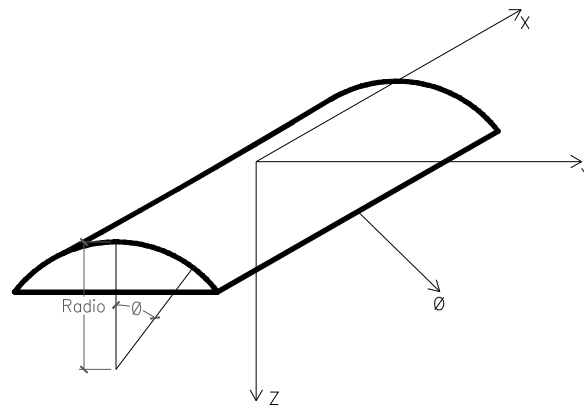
2 Esquema estructural : Lámina, ejes coordenados
